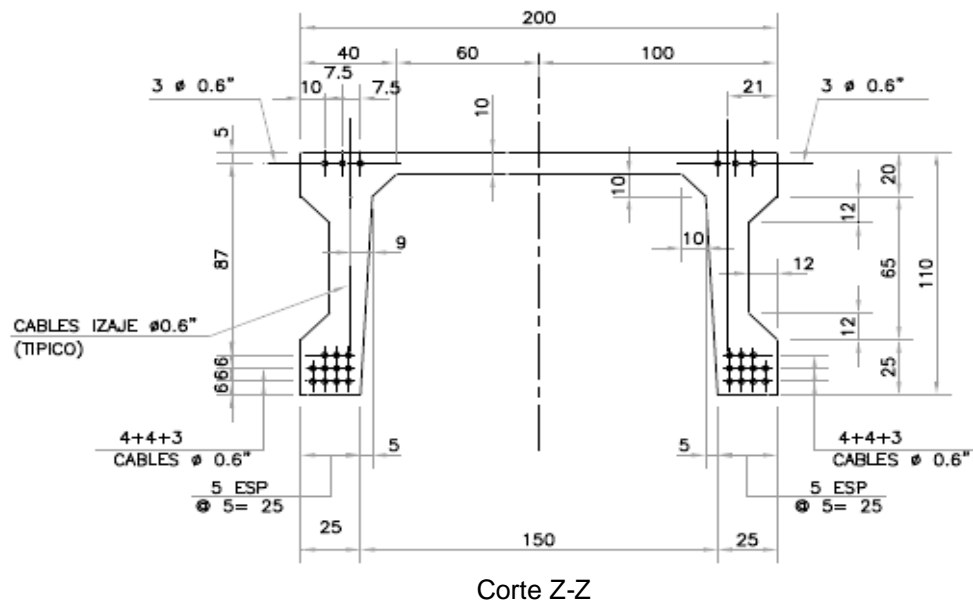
Sección transversal unidad pretensada prefabricada compuesta por dos vigas.
